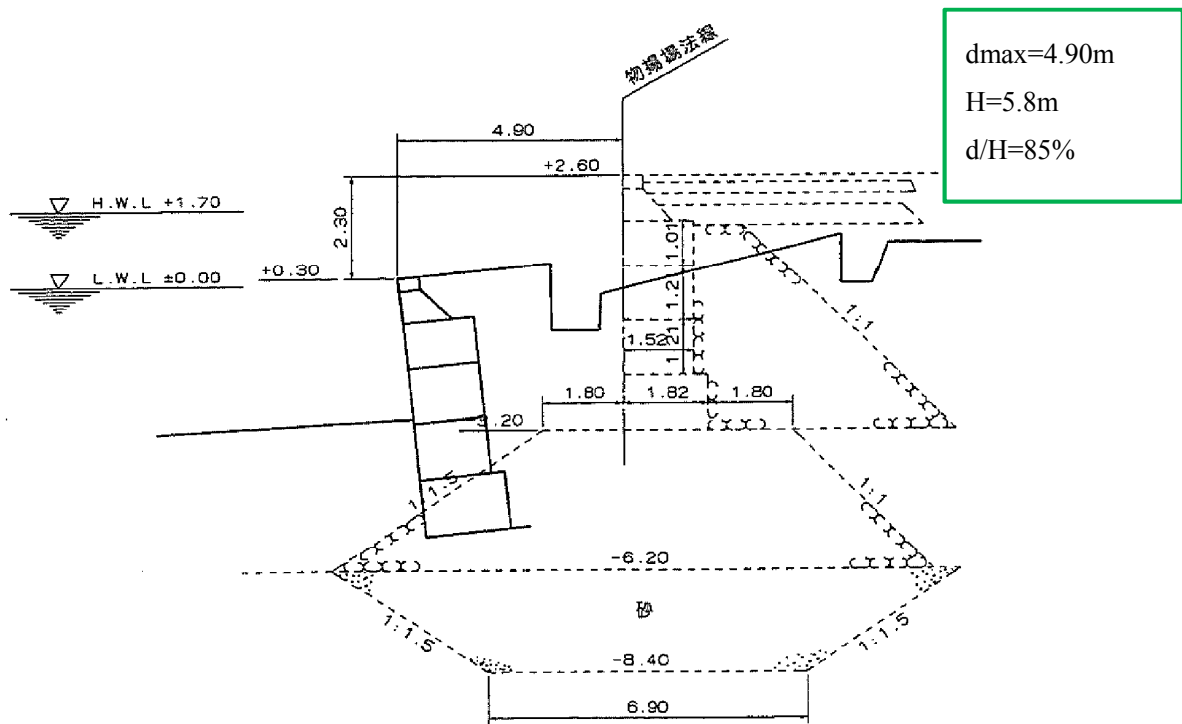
神戸港中突堤地区メリケン波止場東物揚場 (-2.7m) 被災状況断面図
